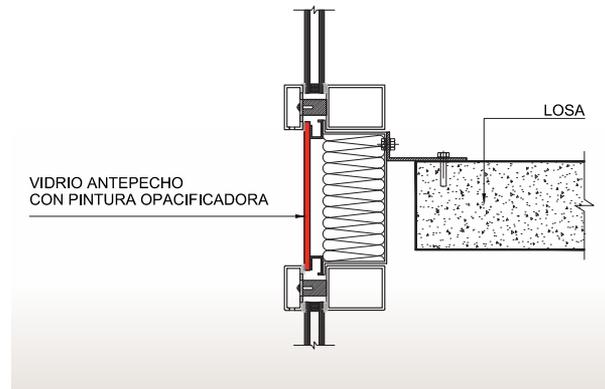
Detalle de vidrio de antepecho opacificado, frente a la losa de piso.
